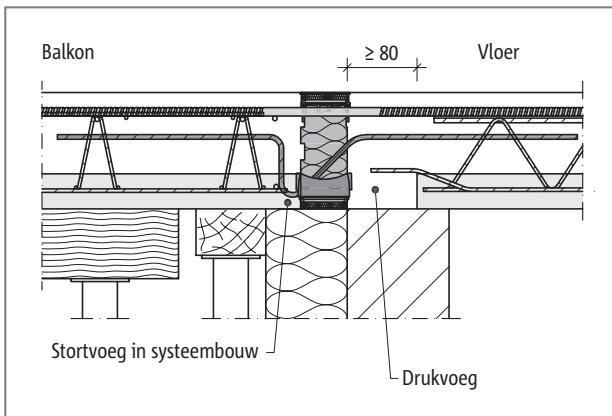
Schöck Isokorb® CT type K-T: volledig afgewerkt balkon met verhoogde vloerplaat op geprefabriceerde betonnen wand van
